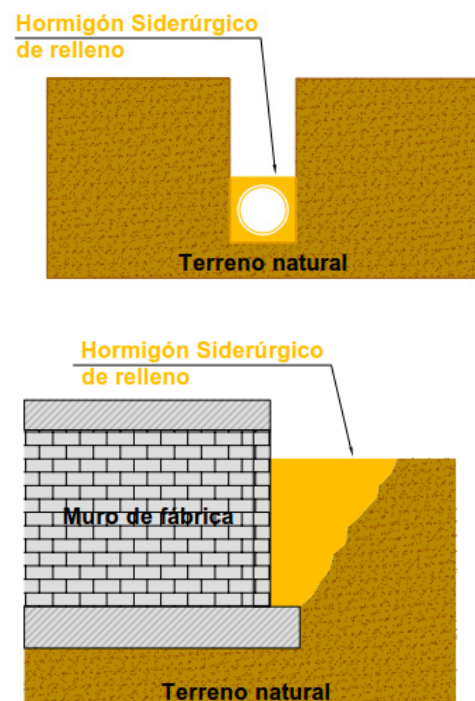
HORMIGÓN DE RELLENO NO ESTRUCTURAL EN ZANJAS Y EN TRASDÓS DE MUROS DE FÁBRICA.
